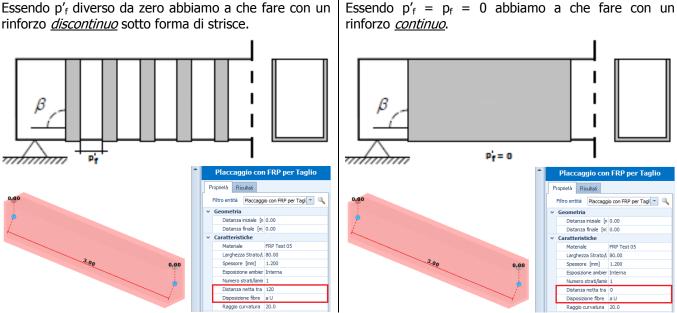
vista - "Interventi CA + proprietà intervento"
